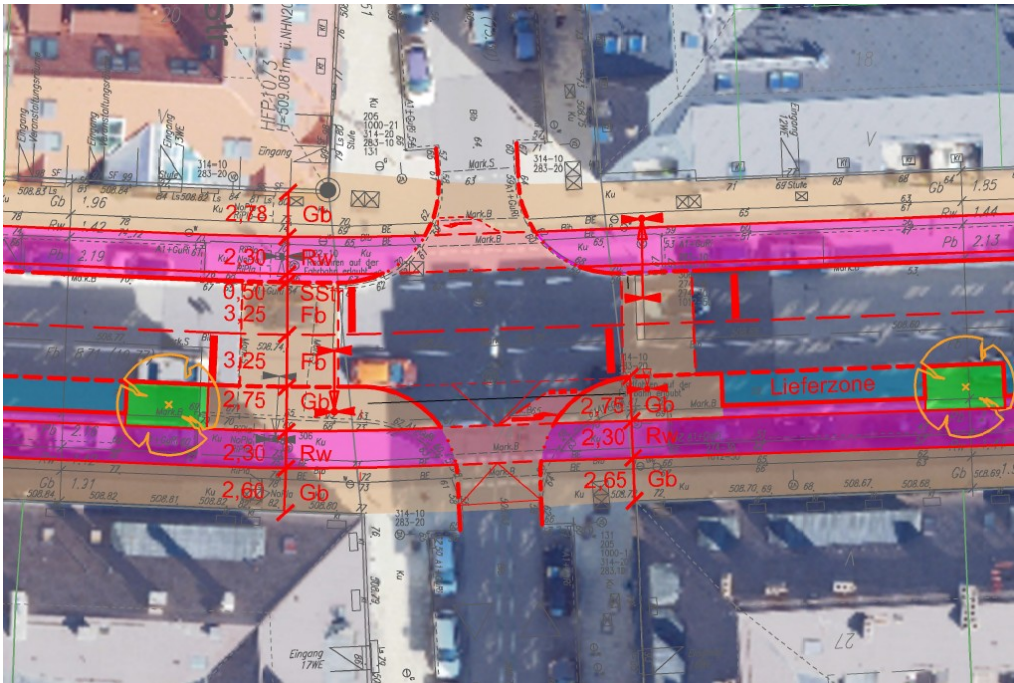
Darstellung Schauplan Knotenpunkt Mainzer Straße / Rheinstraße - Planung Variante 2 (Quelle: Ing.-Büro Zimmermann)
